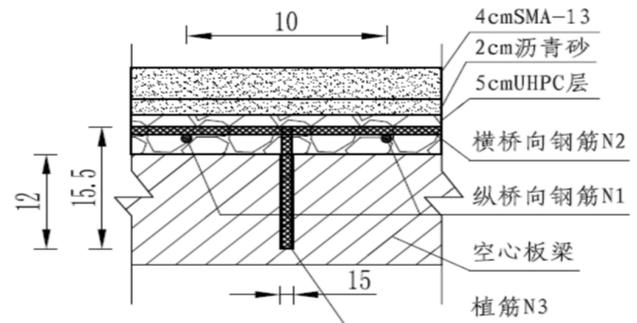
高性能混凝土-普通混凝土叠合层植筋构造图
